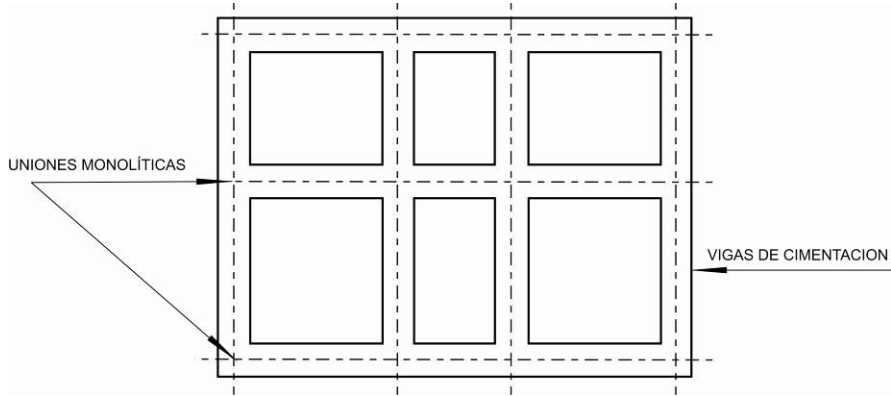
Sistema reticular de vigas que configuran anillos cerrados y continuos
